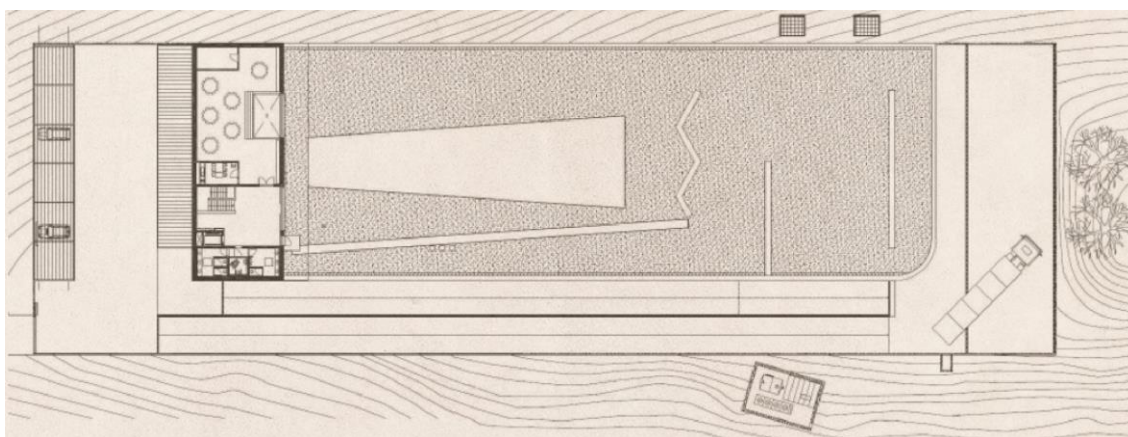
Planta de Cobertura da adega Mayor ²⁴¹
